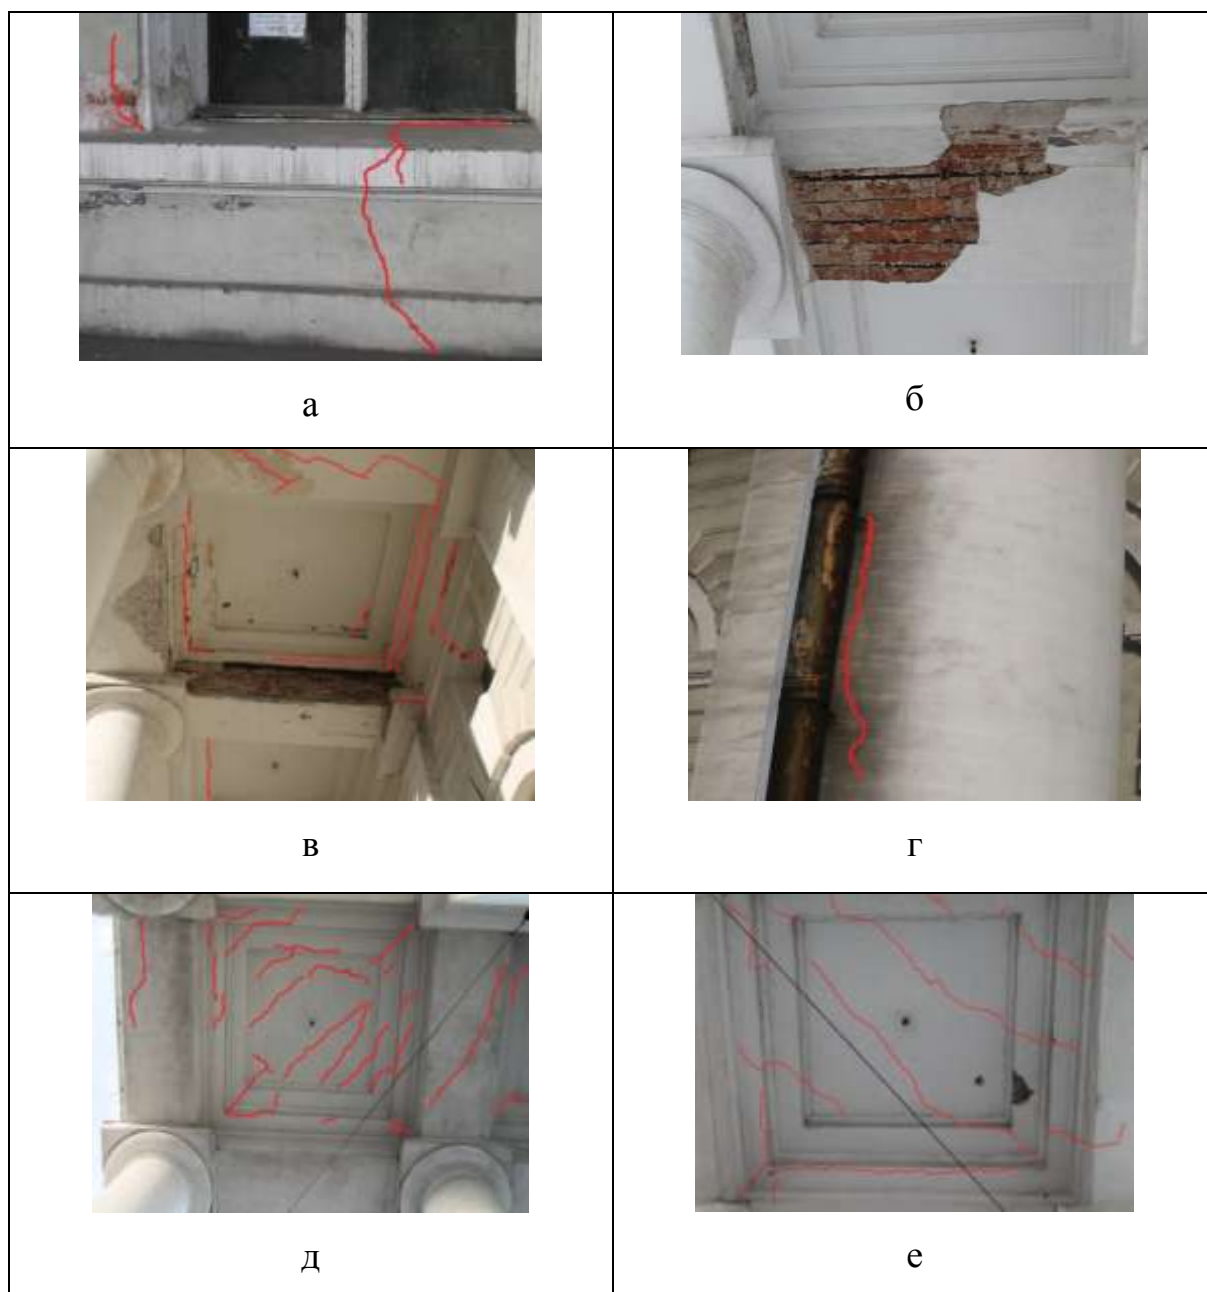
Развитие трещин в несущих конструкциях здания Биржи: а - восточный фасад; б - южный фасад; в, г - северный фасад; д, е - западный фасад (автор фотографий: Ахметшина Р.М.)
